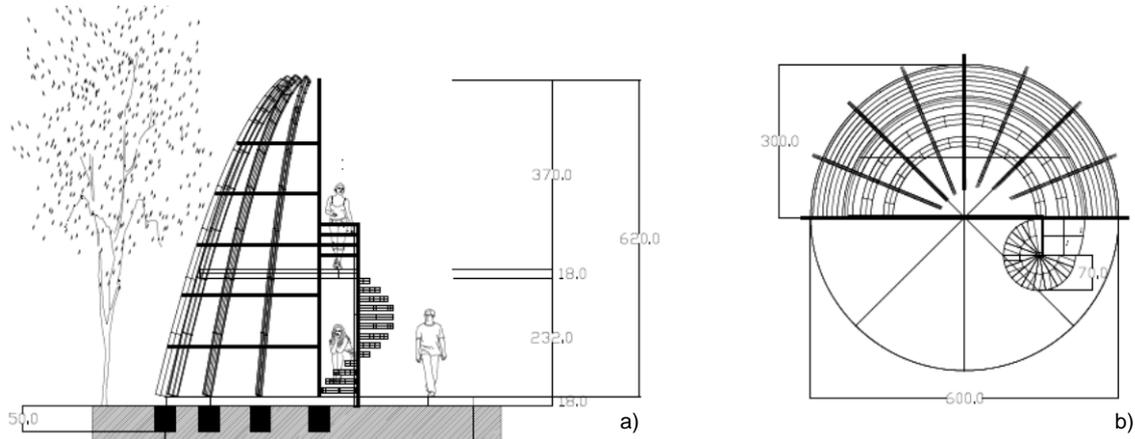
Esquema del anteproyecto mostrando principales elementos prefabricados: a) vista lateral; b) esquema de la planta (elaboración propia)
